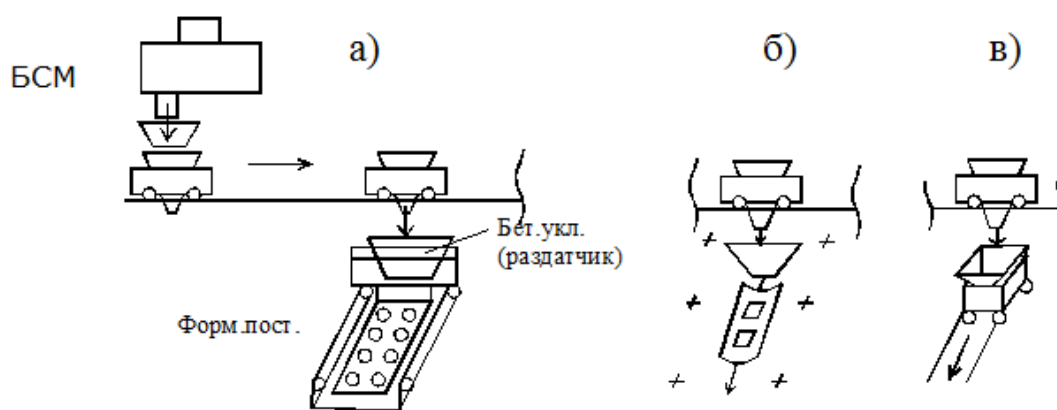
Варианты схем подачи бетонных смесей бетоновозными эстакадами:
